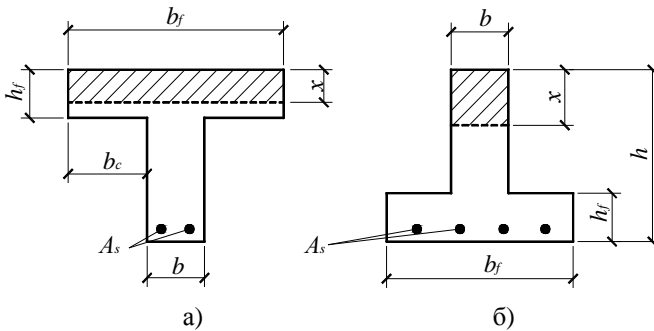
Таврові профілі з полицями у стиснутій зоні (а) і в розтягнутій зоні (б) поперечного перерізу
